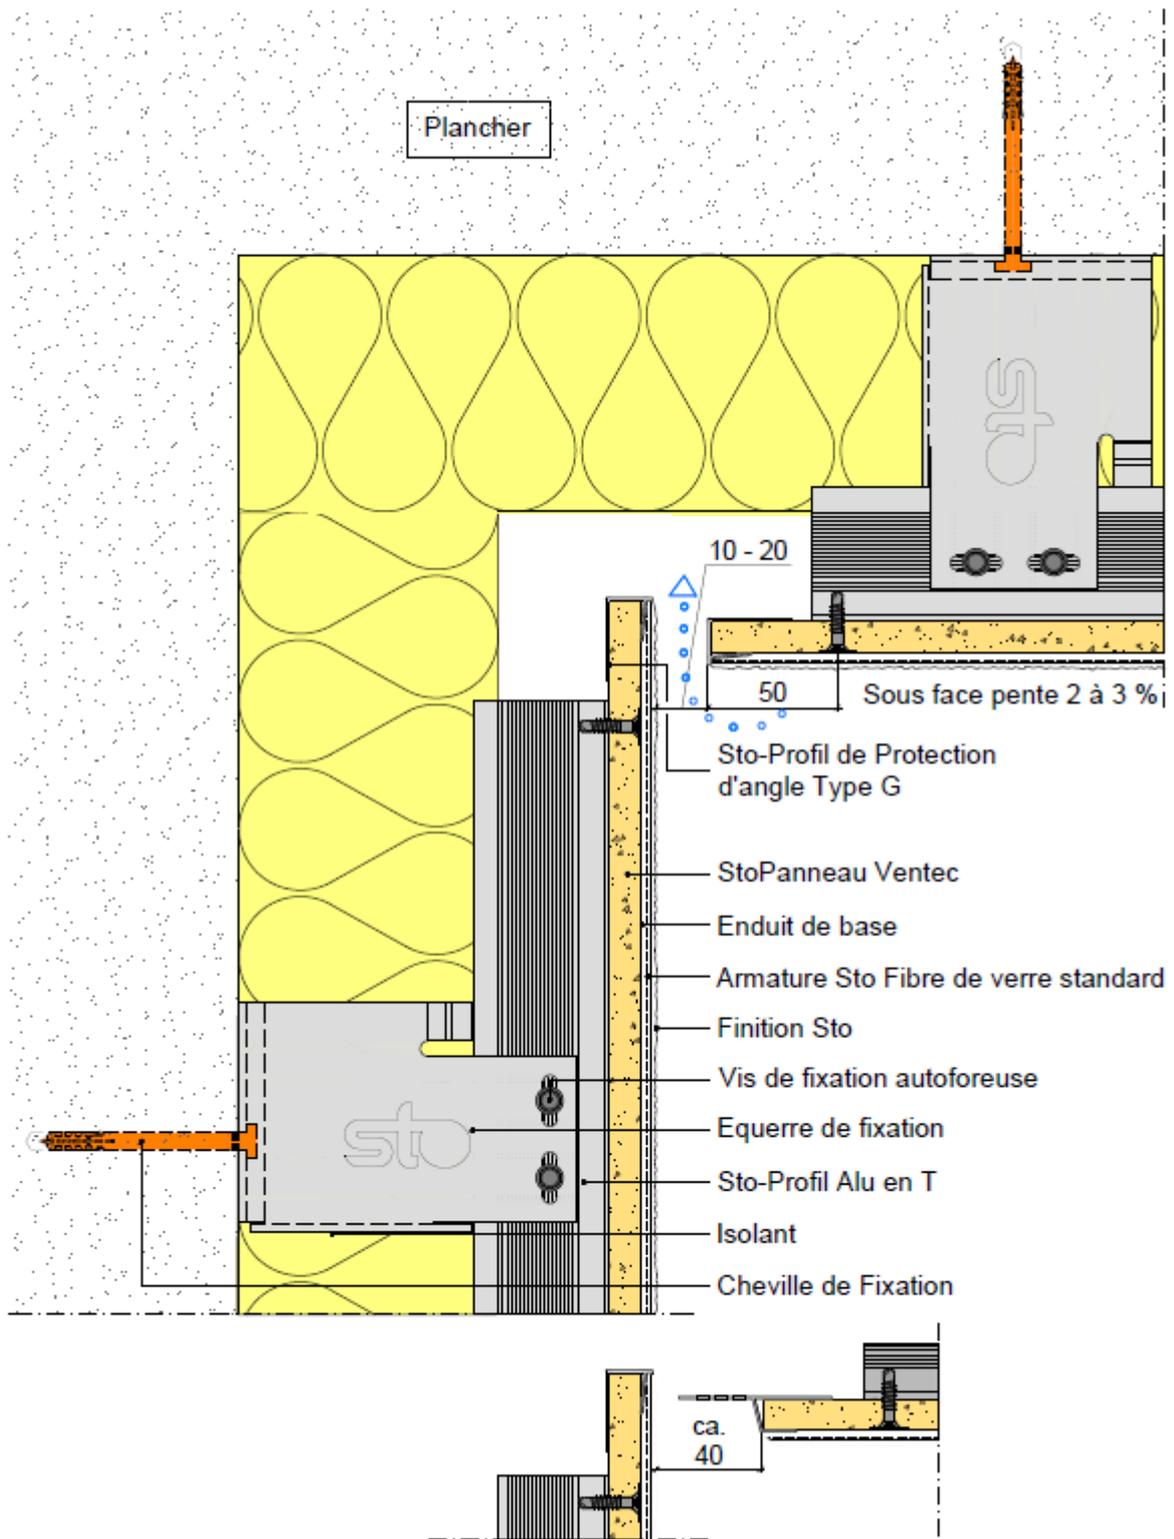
Coupe verticale - Pose en sous-face - Interface entre la sous-face et le bardage en retrait de la façade - Ossatures aluminium sur support béton
